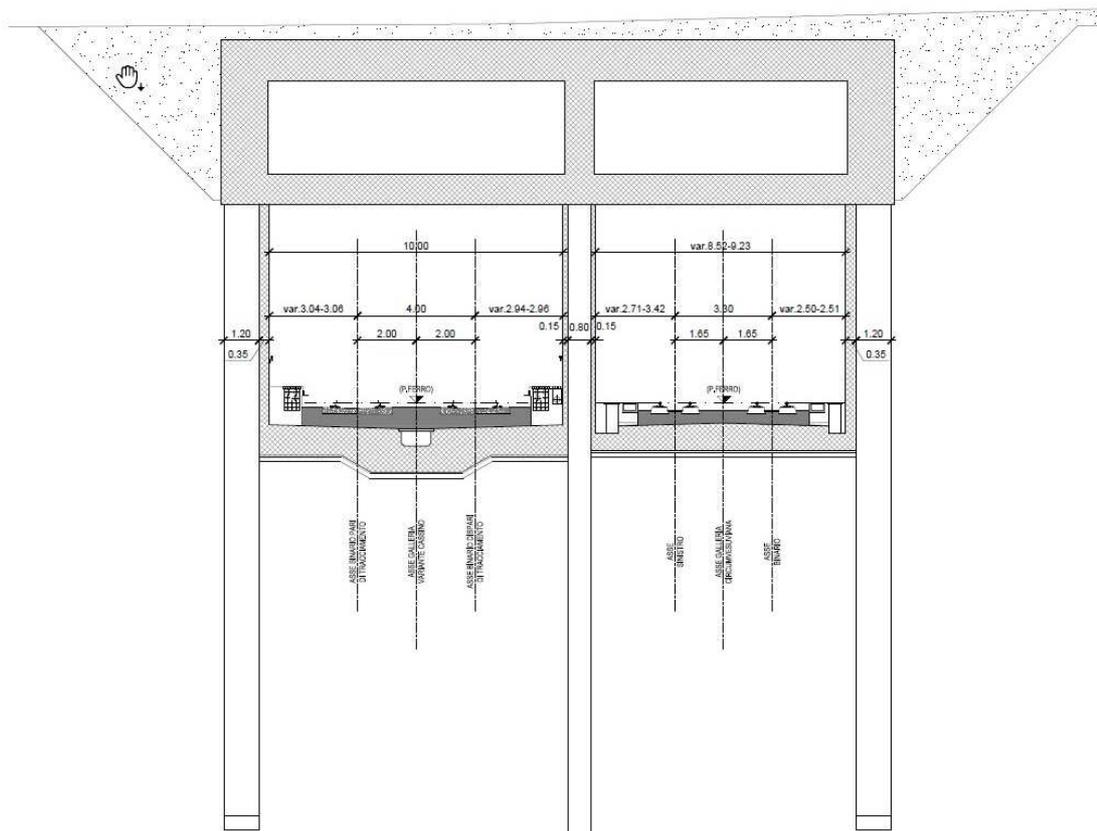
Sezione trasversale a doppia canna con piano mezzanino di tipo H. (da elaborato 1.f)
